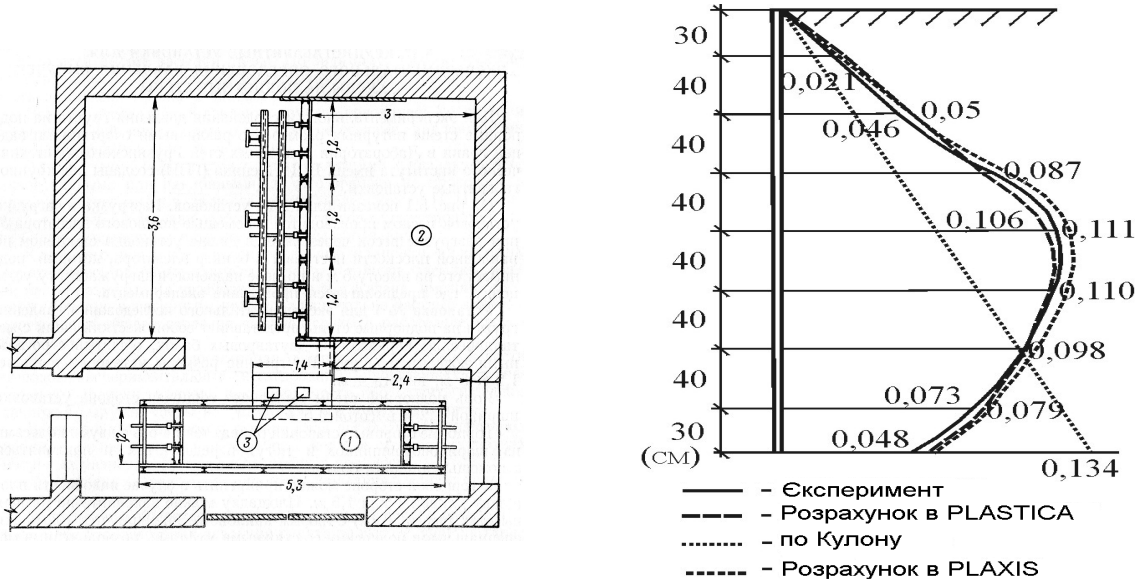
План великорозмірних установок для експериментального дослідження тиску ґрунту на підпірні стіни
